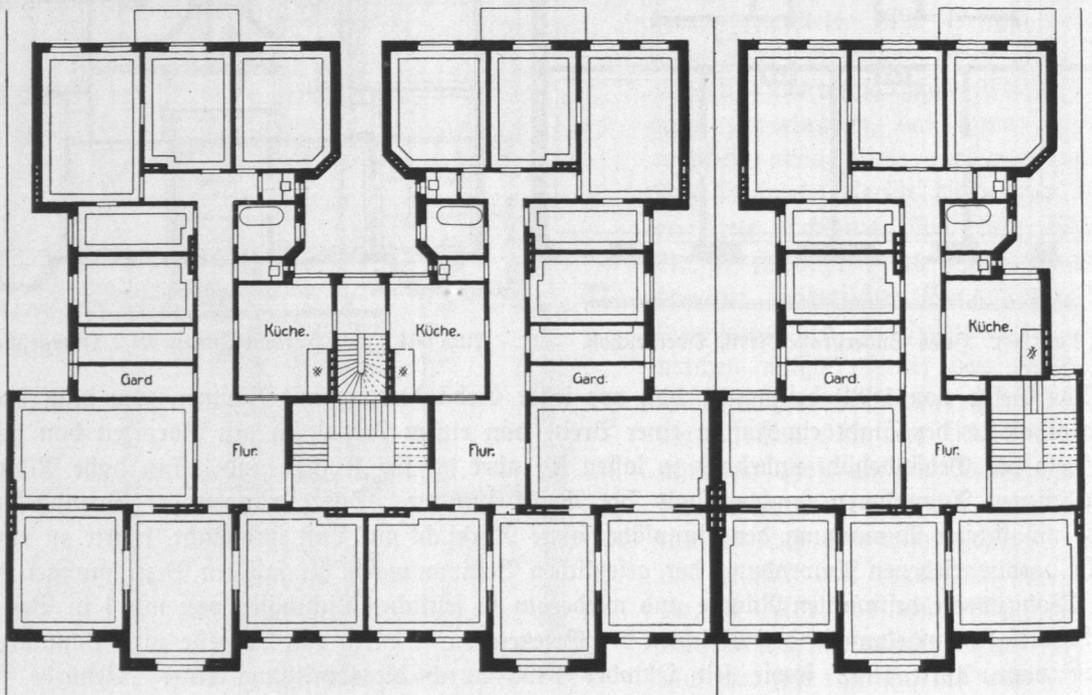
Haus Hartwicusstraße Nr. 3/4, Obergeschoß.
